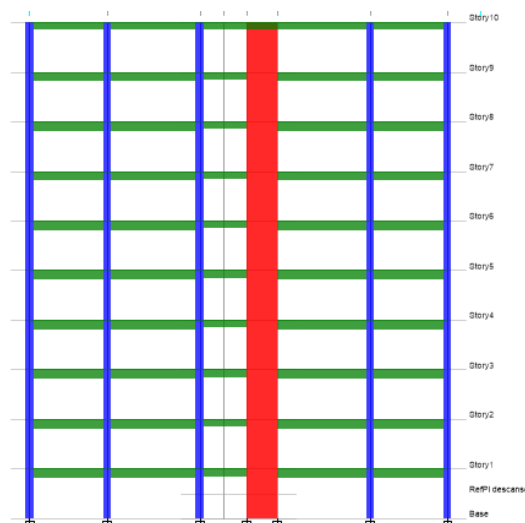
Elevación de las edificaciones con sistema tradicional aporticado. ETABS 2016 [14]
